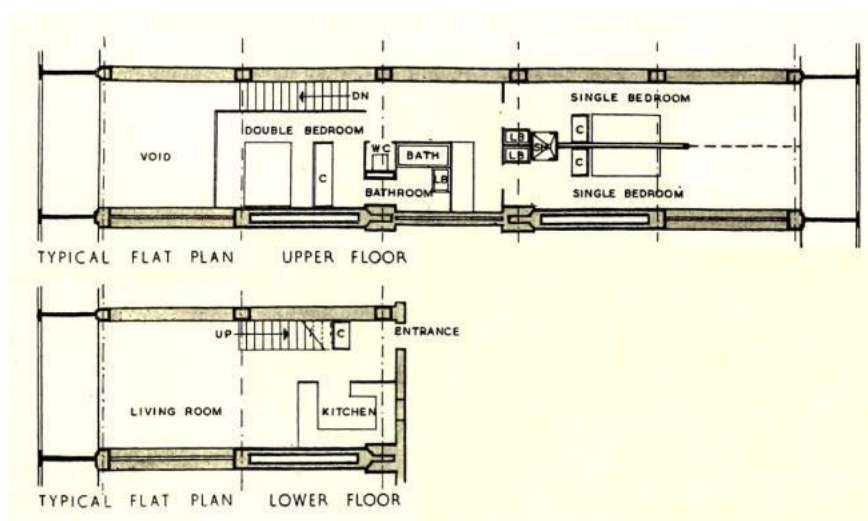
Planta baixa do pavimento tipo da Unité d’habitation de Marseille do arquiteto Le Corbusier
